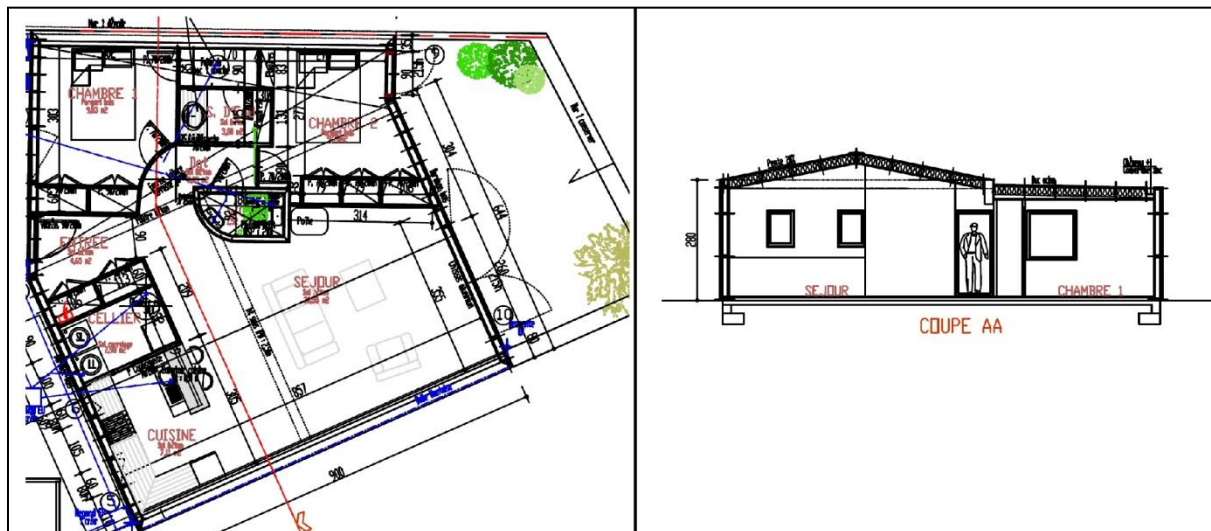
Plan et coupe de la petite maison (Babel Ouest)
